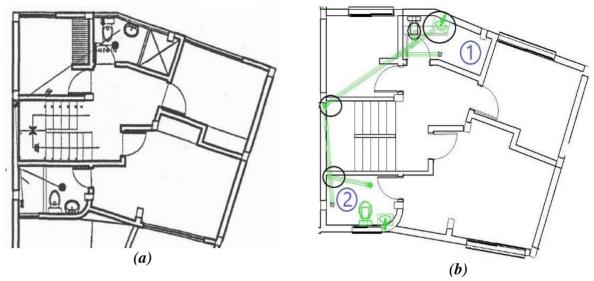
Plano en planta de la casa tipo 4 en el sistema CAD (a). Plano en el sistema BIM, se resalta la unión de tuberías y un choque con la escalera (b).
